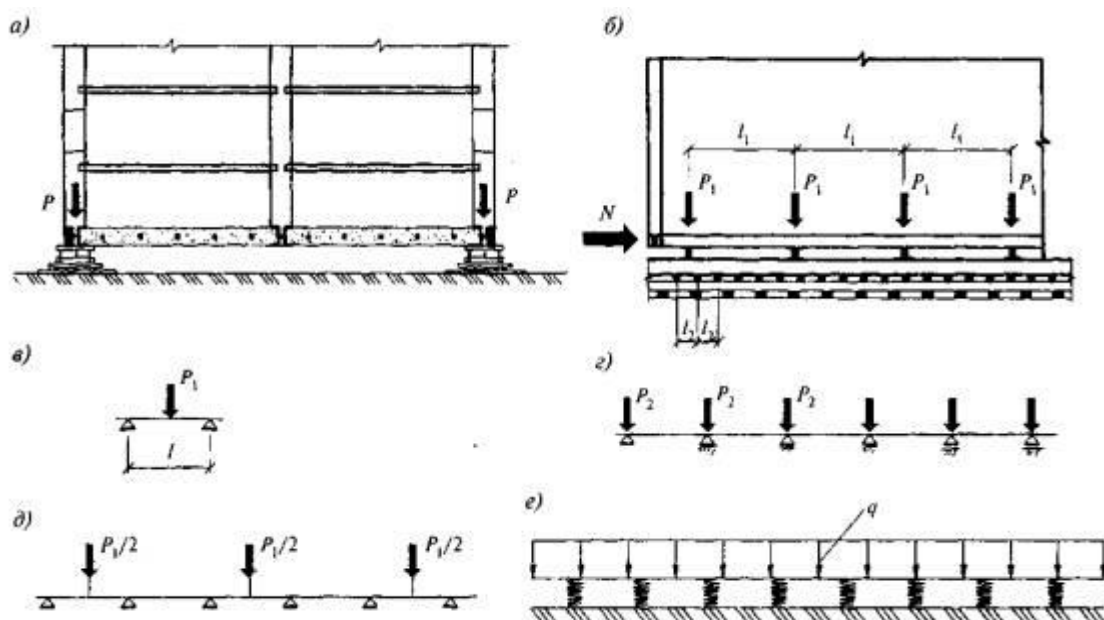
Схема передвижки здания на выносных опорах (а, б) и расчетные схемы элементов (в, г, д, е)
